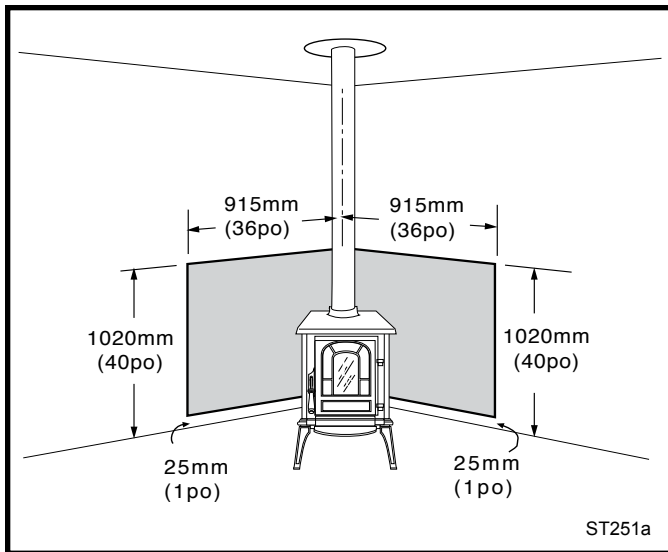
Installation en coin avec conduit de raccordement vertical et double écran mural pare-chaueur.
